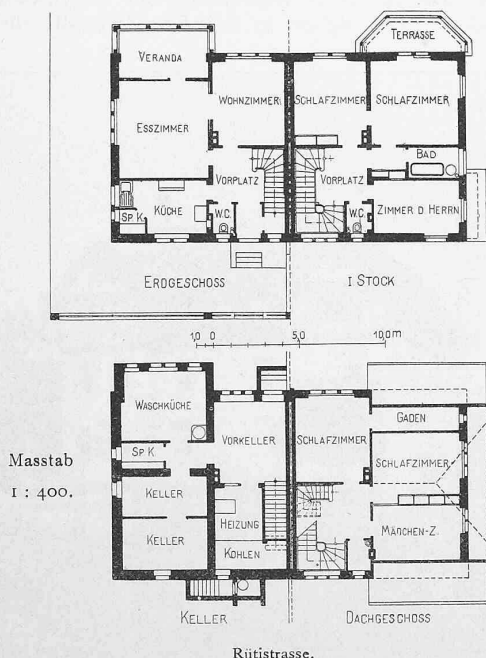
Grundrisse der Doppelvilla an der Rütistrasse in Zürich V.
